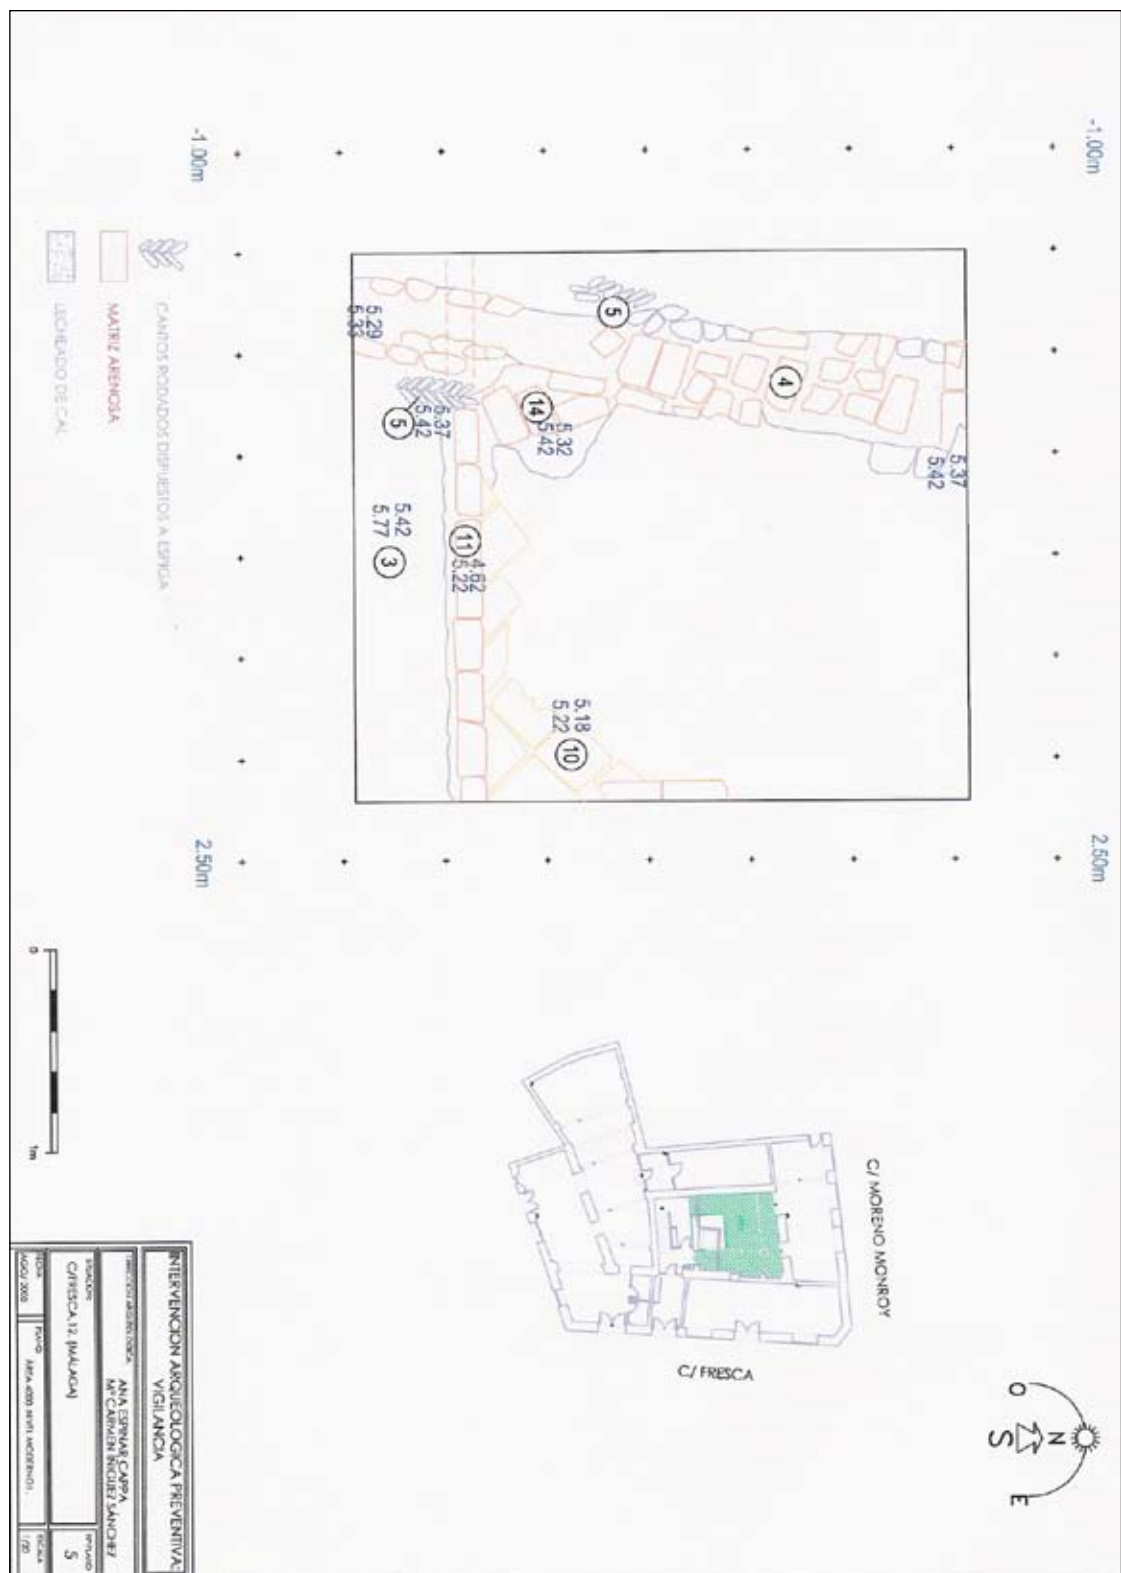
Plano 5: Área 4.000 – Planta Nivel Moderno I
